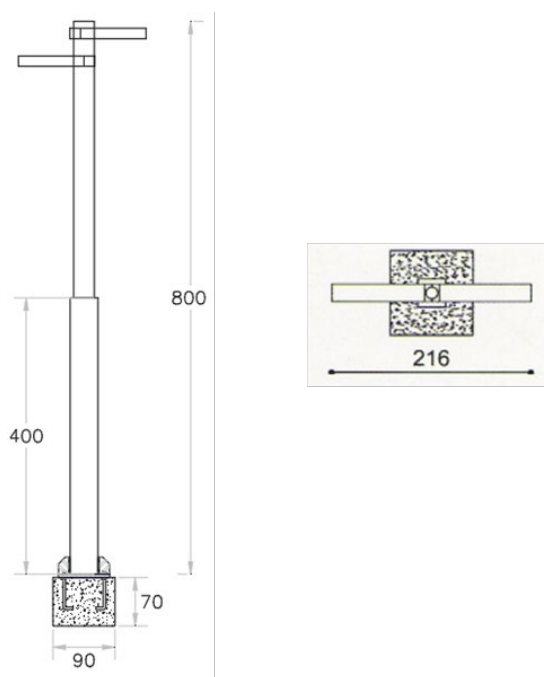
Iluminación. Fuente y elaboración: Autores.
